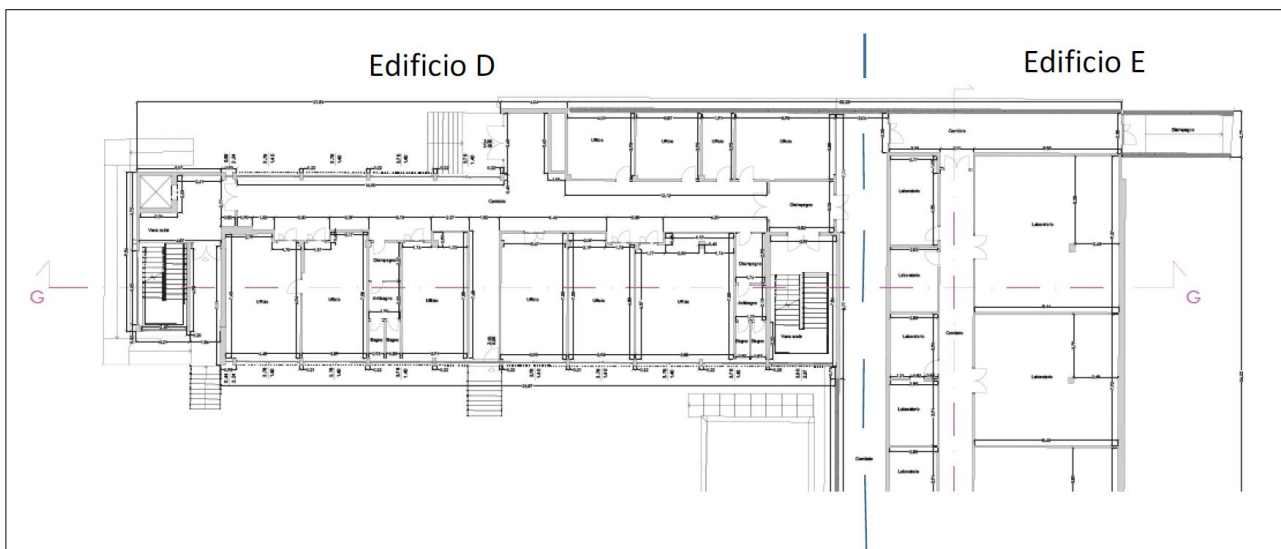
Pianta stato di fatto p.t. edifici D ed E (dal rilievo del geom. Giuseppe Morena)
